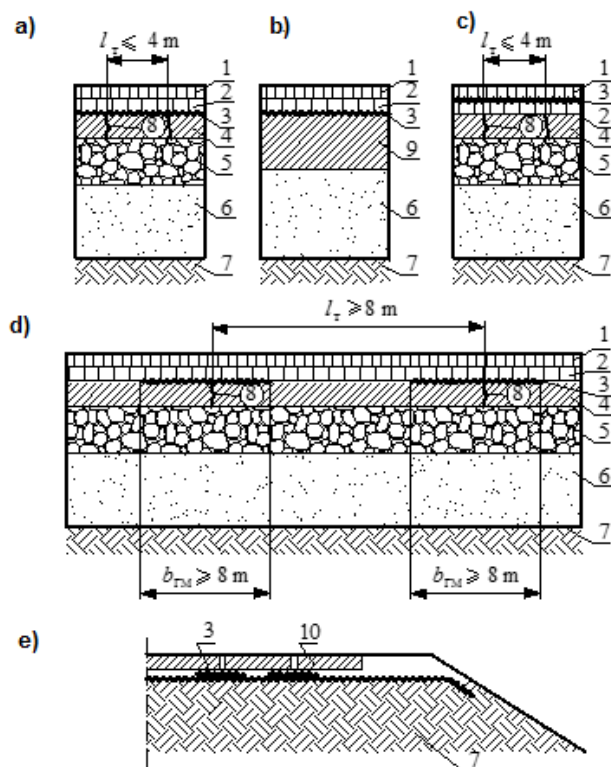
Soluții constructive de bază pentru executarea substraturilor cu rol de protecție și armare din MG în straturile îmbrăcămintei bituminoase (a-d) și sub îmbrăcămintea din beton armat prefabricat (e)
